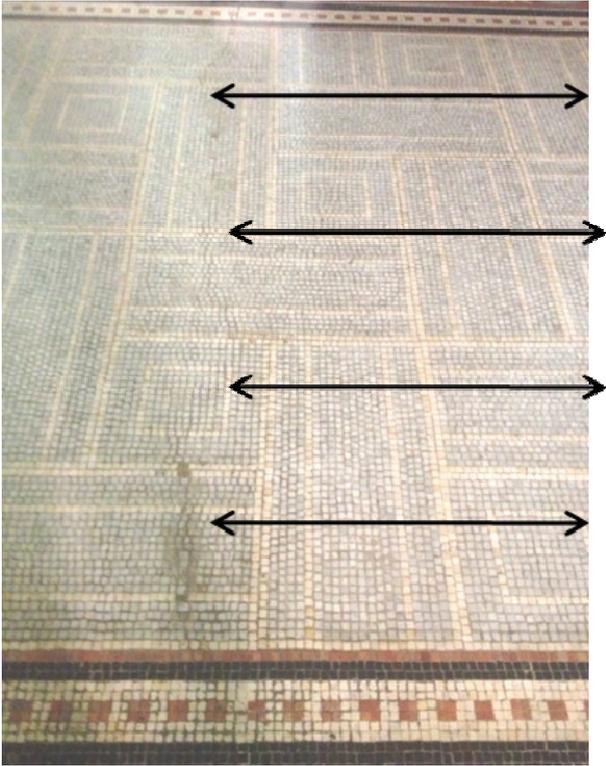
Mosaico I . Pavimento superior do Palácio Lauro Sodré: trajetória de fissura transversal
